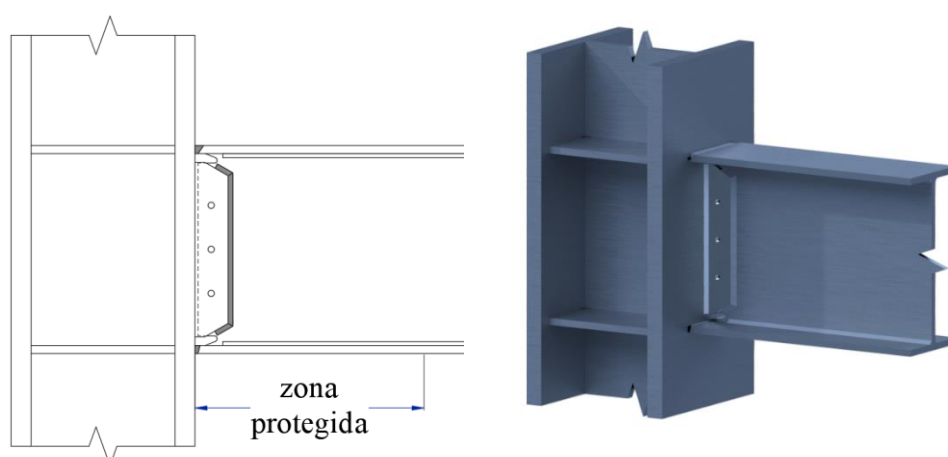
Detalles generales de la conexión alma de viga a aleta de columna (ANSI/AISC 358, 2018)
